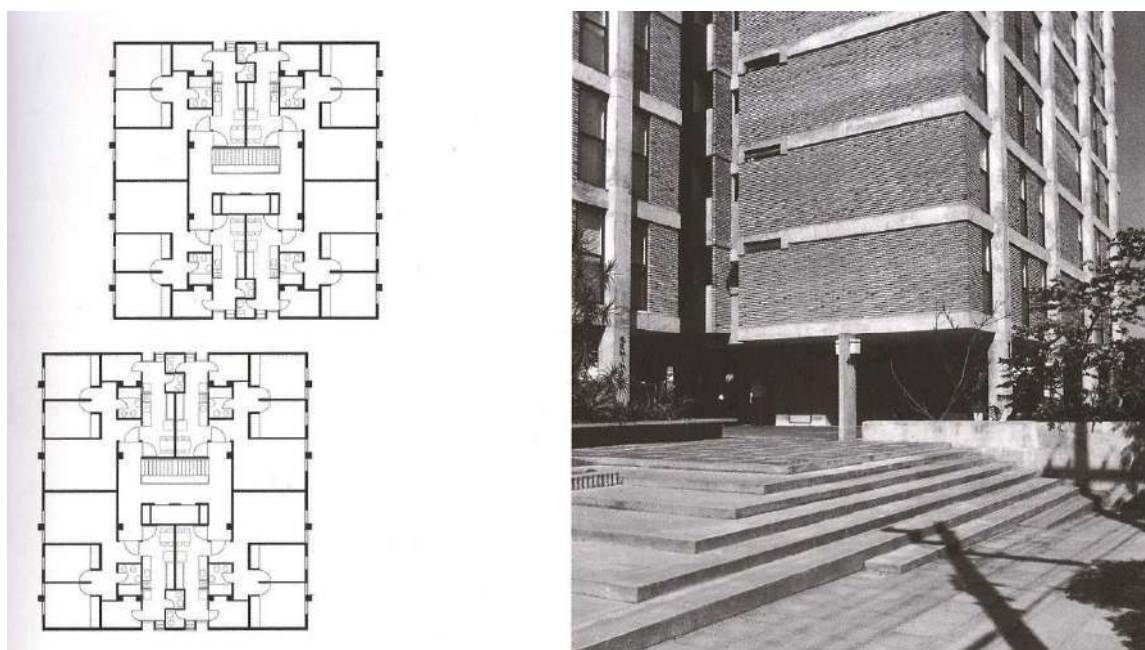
Edifícios Gemini I e II, plantas baixas do pavimento-tipo (esquerda) e vista parcial do pavimento térreo (direita).
